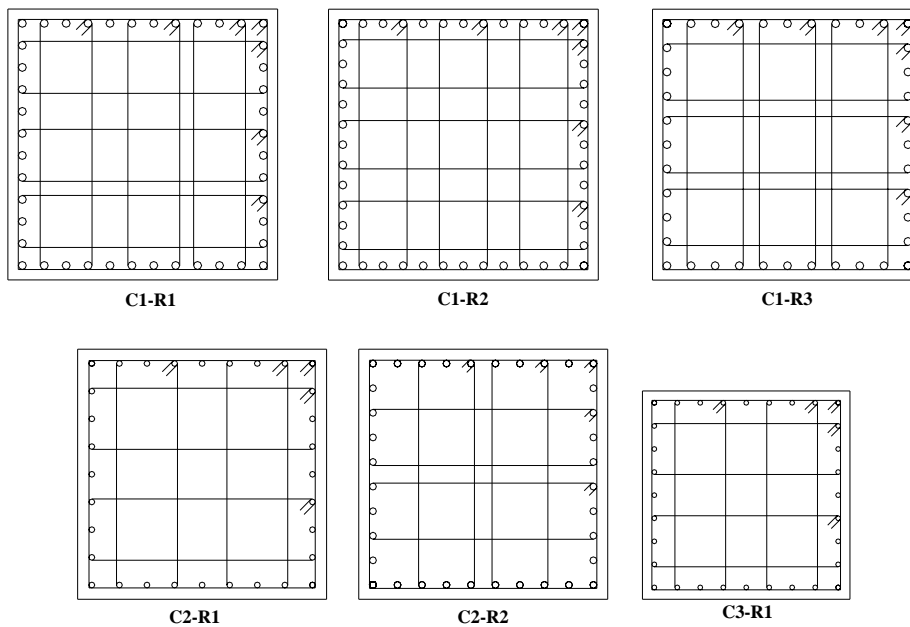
Secciones y refuerzos de las columnas del modelo M1Q3AA
